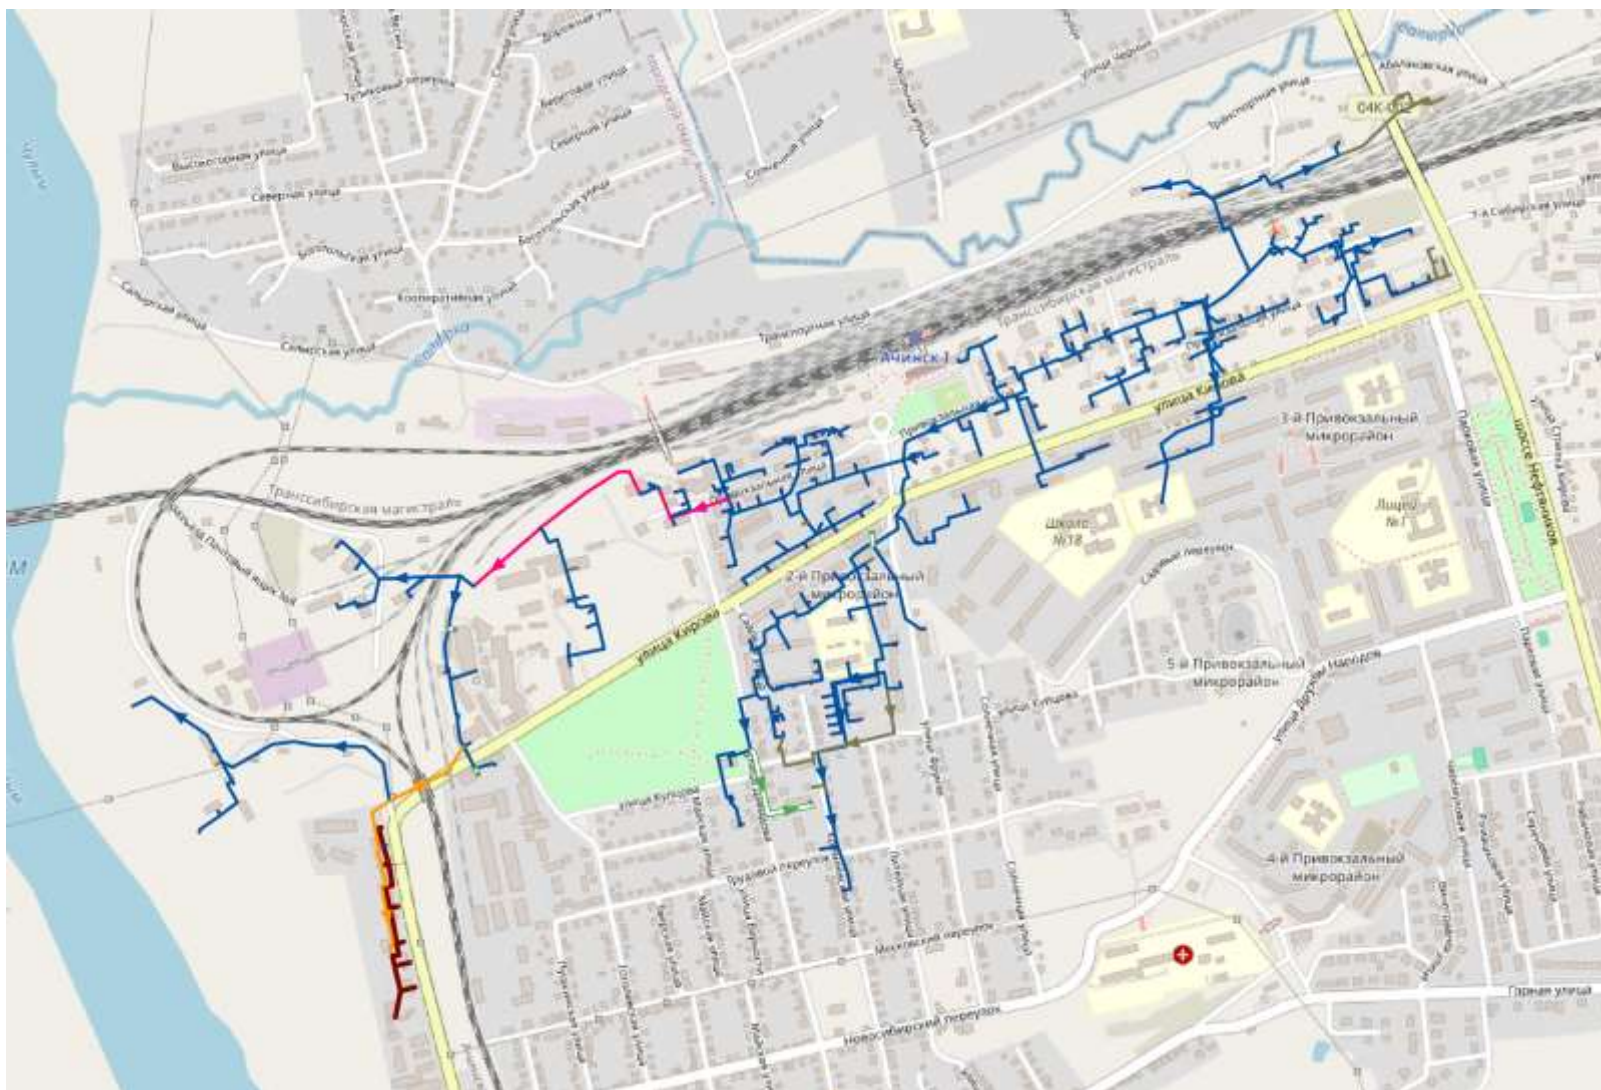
Схема сетей теплоснабжения котельной № 6 ООО «Теплосеть» по варианту № 1
